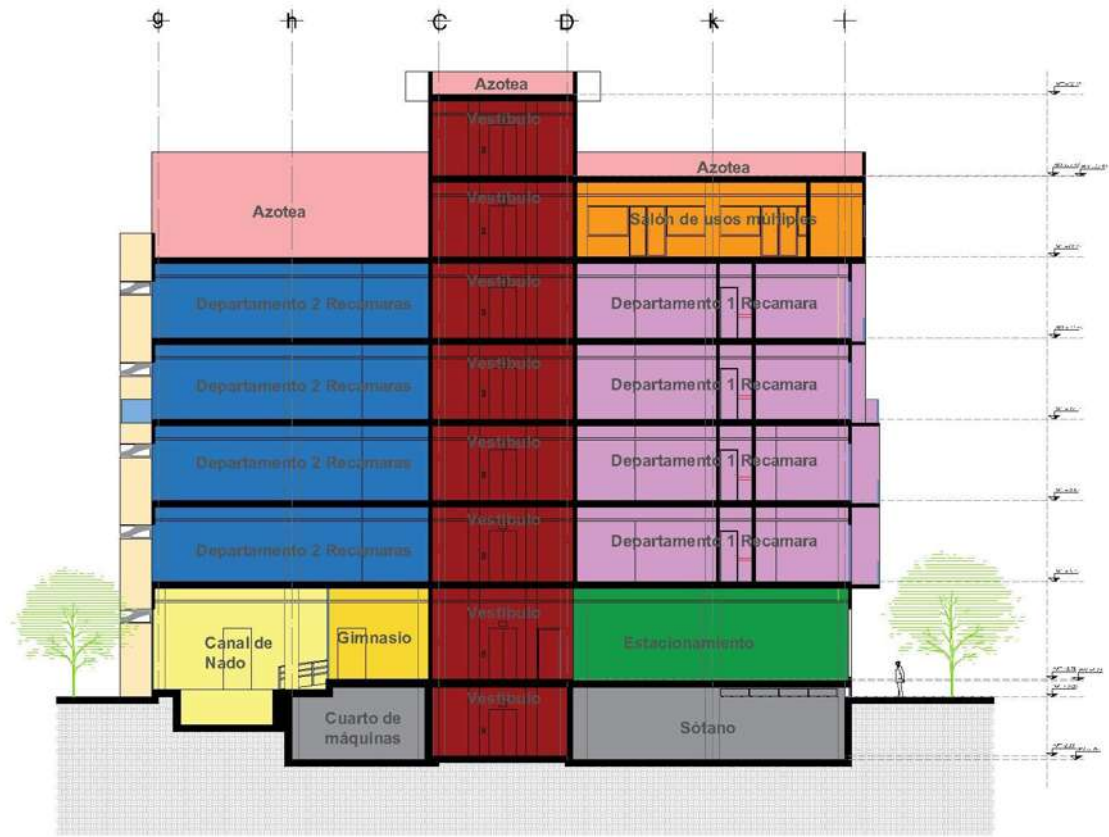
Corte esquemático del edificio. Ileri Loza
